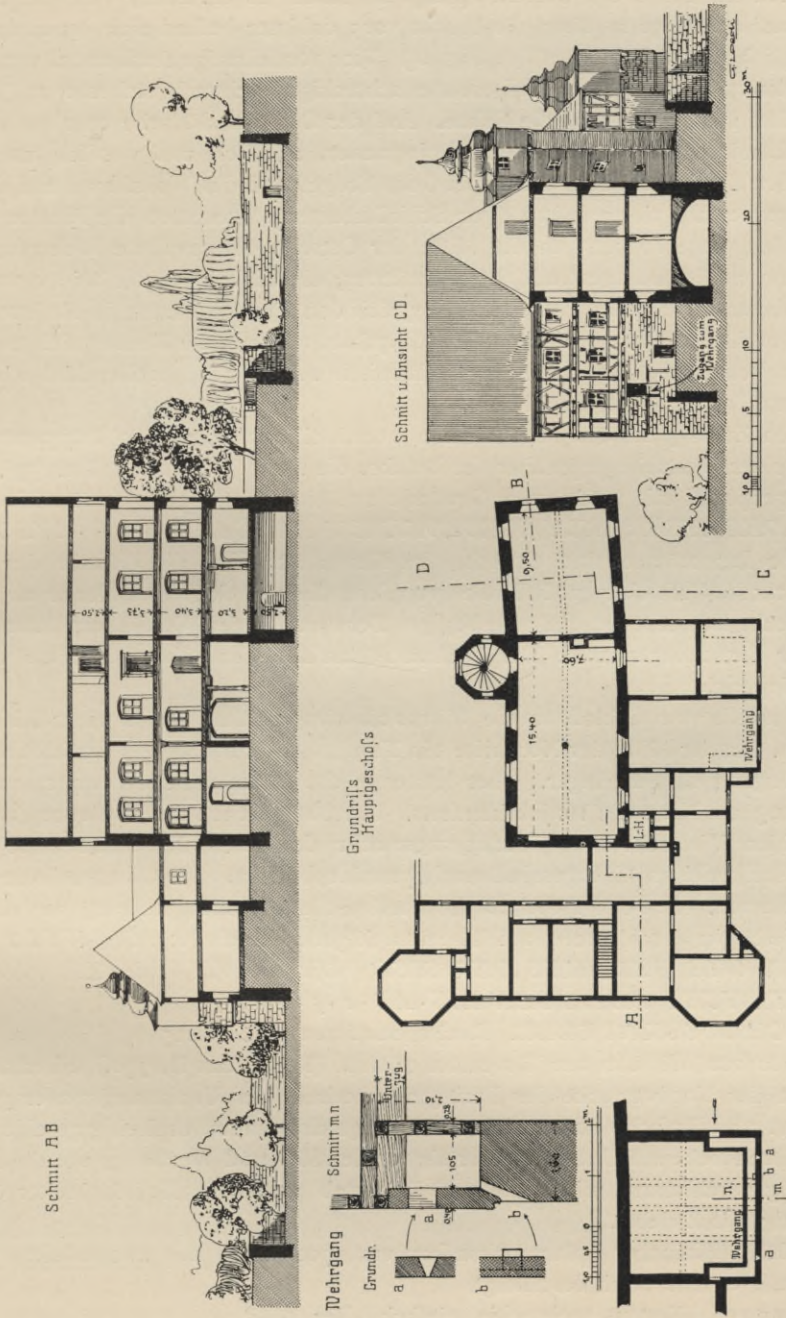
Ebelsbach. Grundriss und Aufriss des Schlosses.
